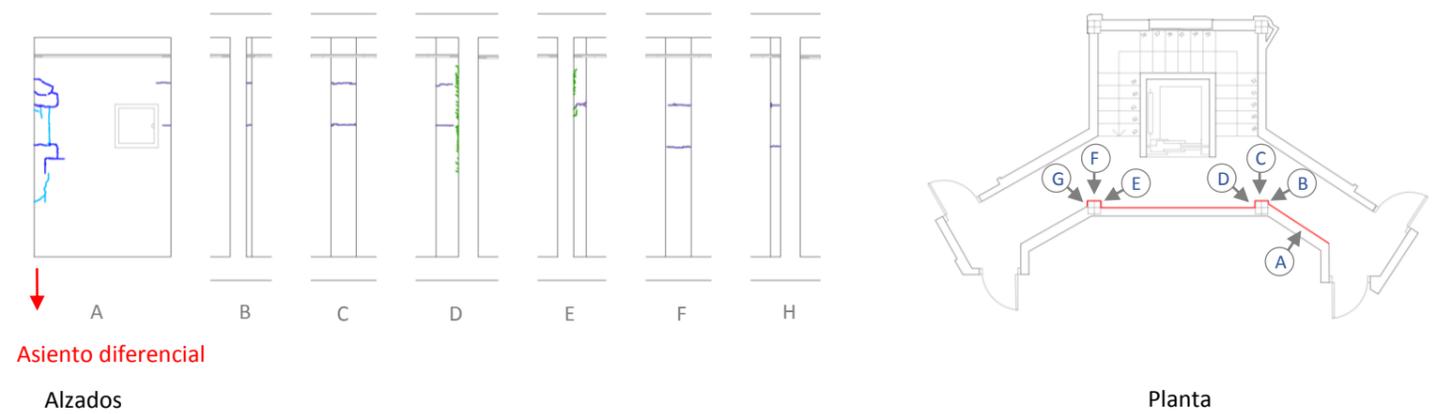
Fisuras grandes/ grietas pasillo planta segunda. 2018. Elaboración propia
